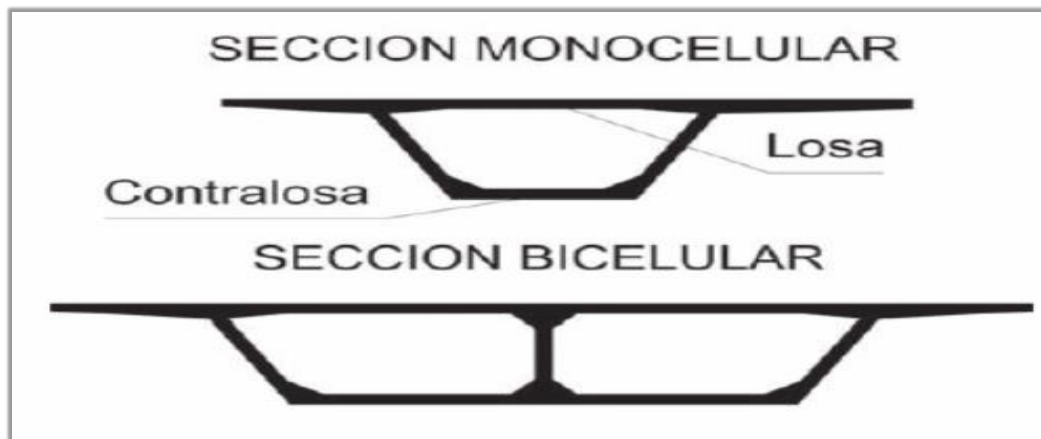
Sección transversal típica de un puente Viga-Losa
